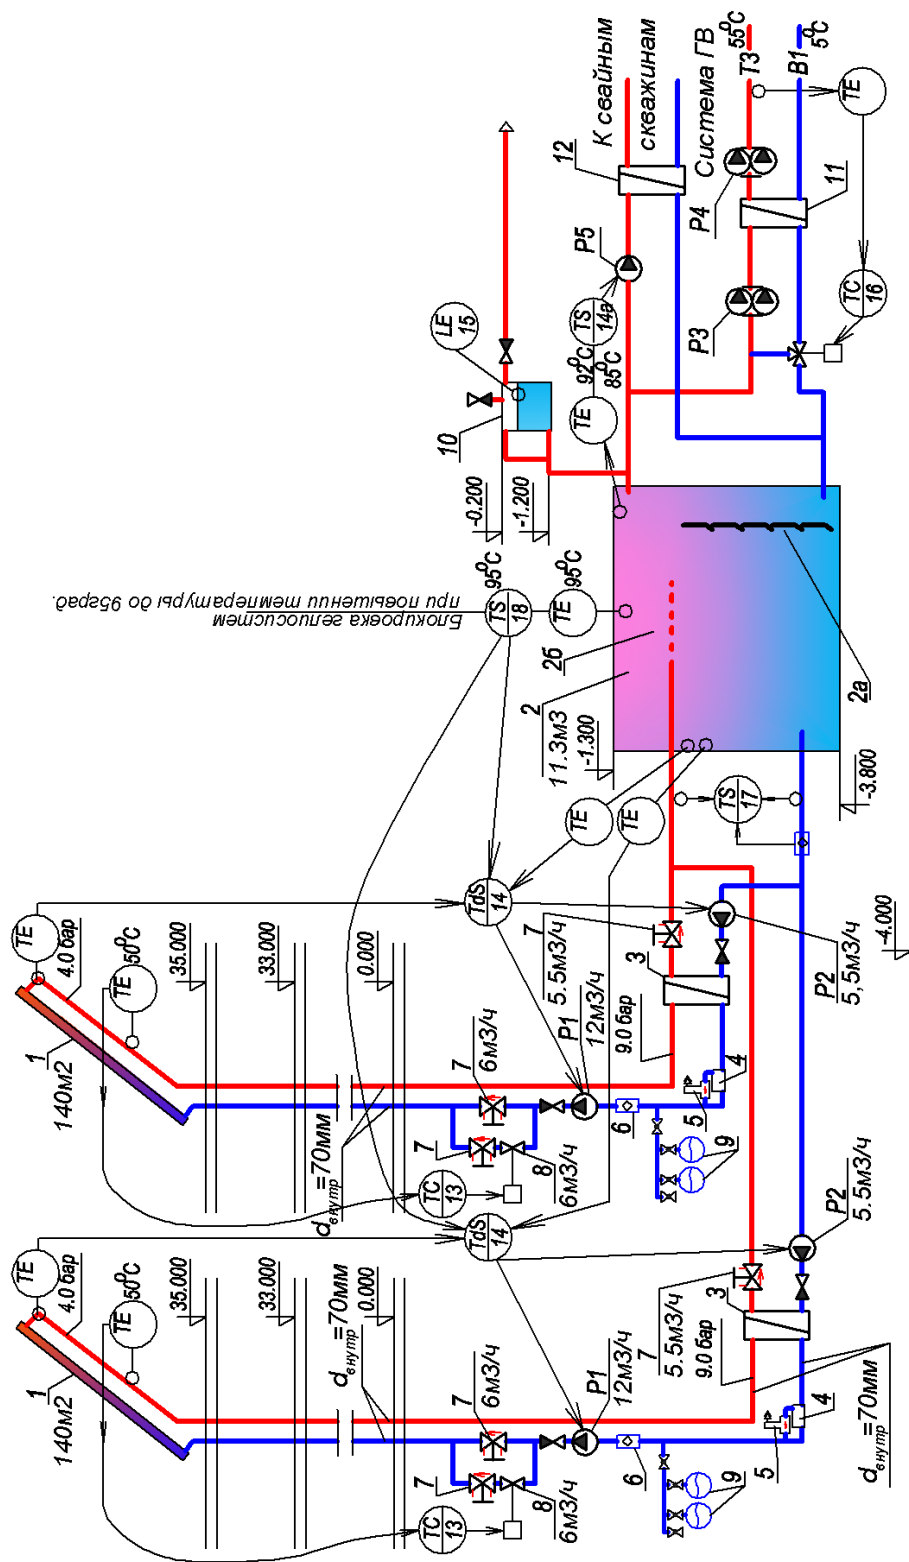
Схема геосистемы 100 квартирногo 10-ти этажного жилого дома
